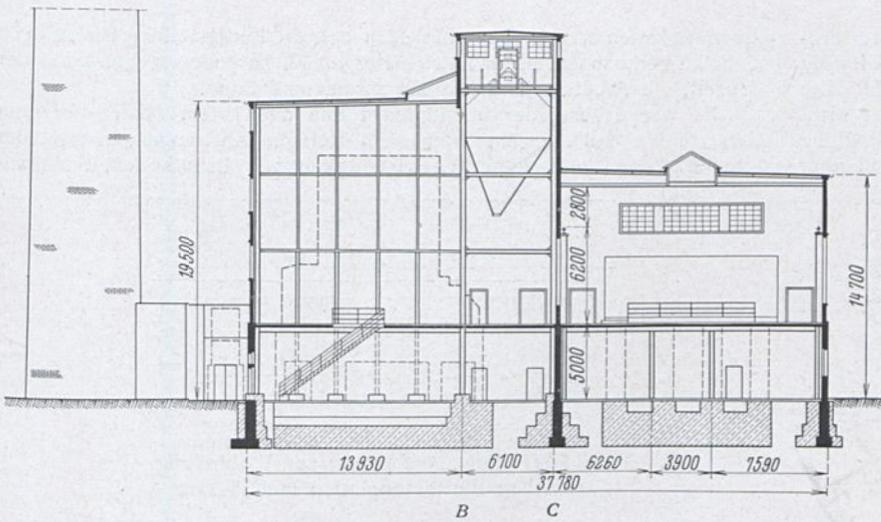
Querschnitt durch Kessel- und Maschinenhaus.
